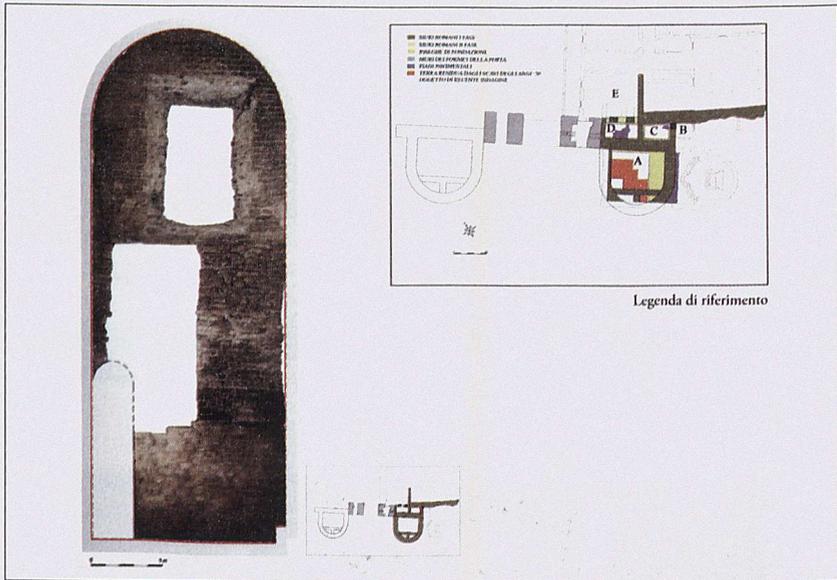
Scavo archeologico della chiesa e della sacrestia di San Michele (2006-08): Pianta dello scavo e prospetto fotogrammetrico della parete Sud/Est del vano C (da V. Lani).
